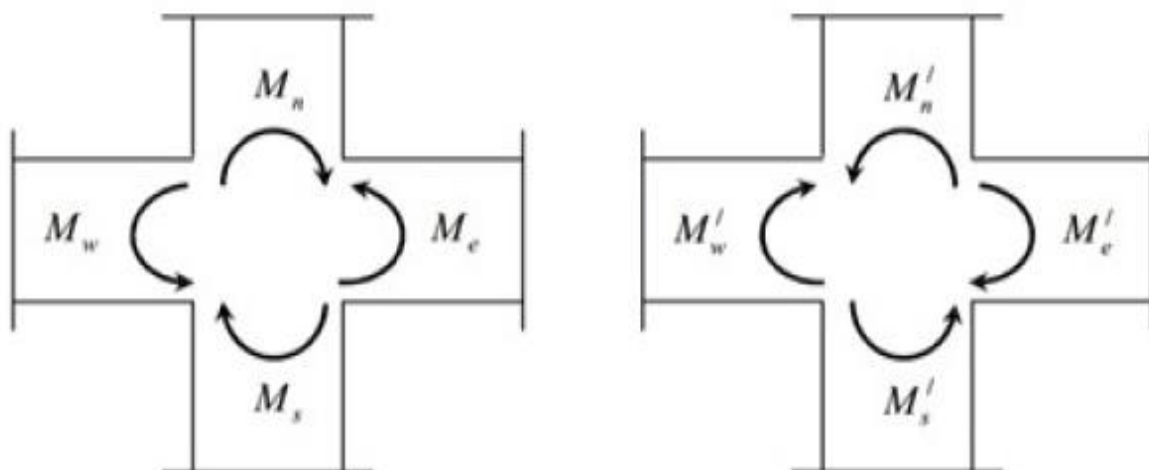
Dimensionnement d'un nœud poteau-poutre [11]
